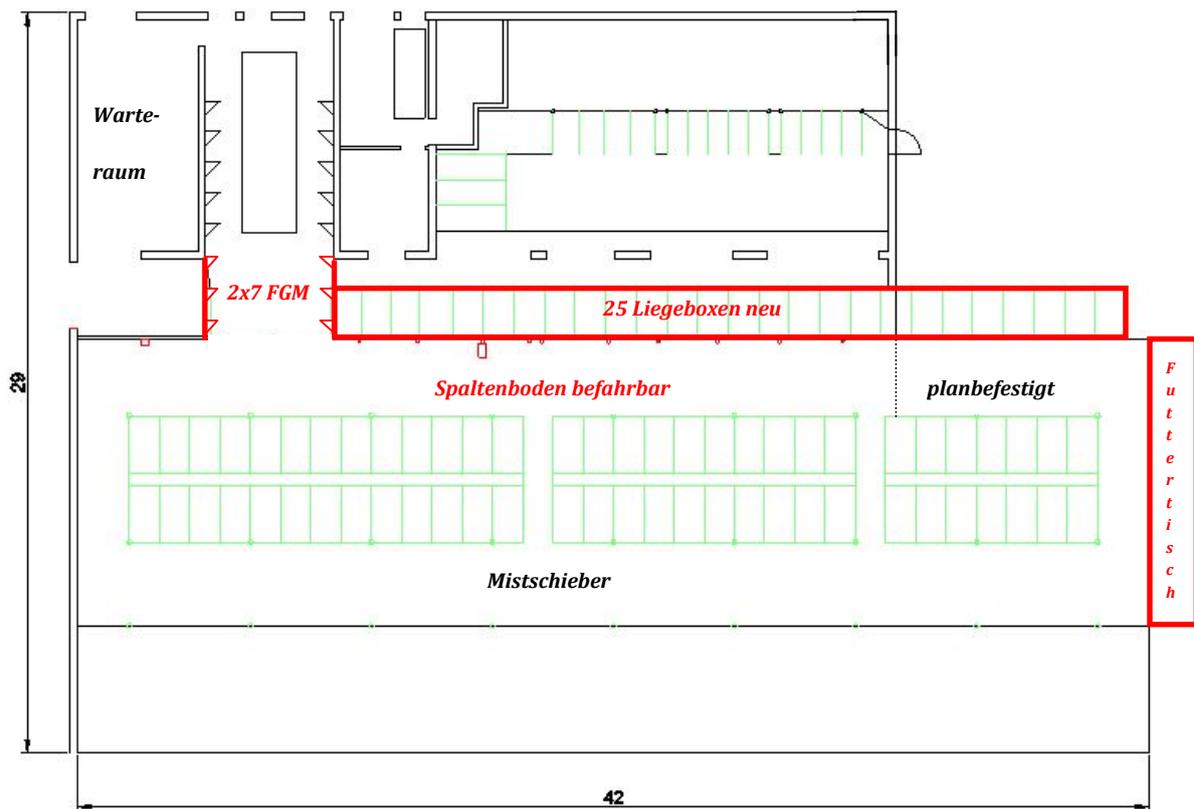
Stallgrundriss nach Umbaumaßnahme
